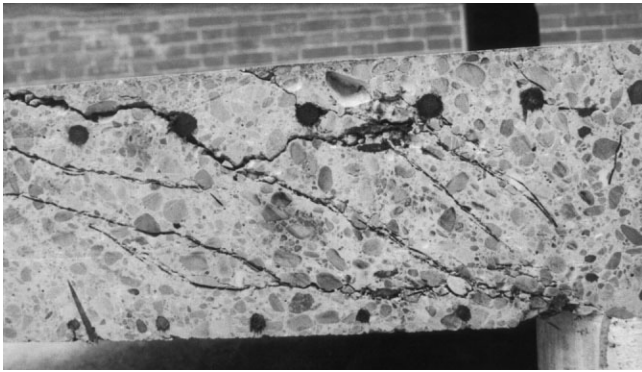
Rißbild bei einer Platte bewehrt mit einem Riss-Stern [12]
